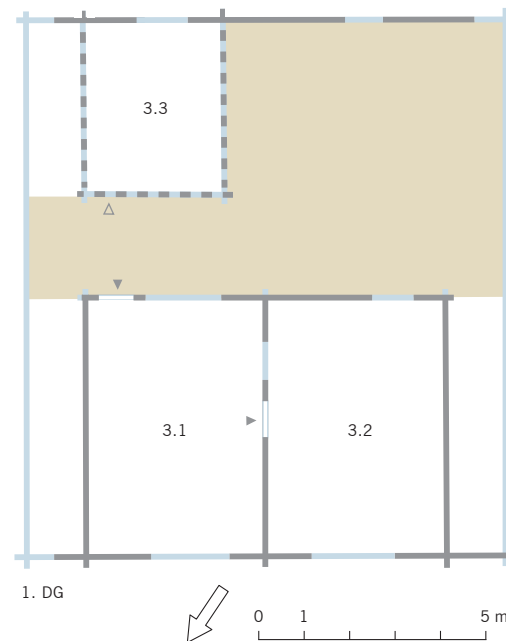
Hauptstrasse 1 in Oberägeri, Grundriss des ersten Dachgeschosses.
